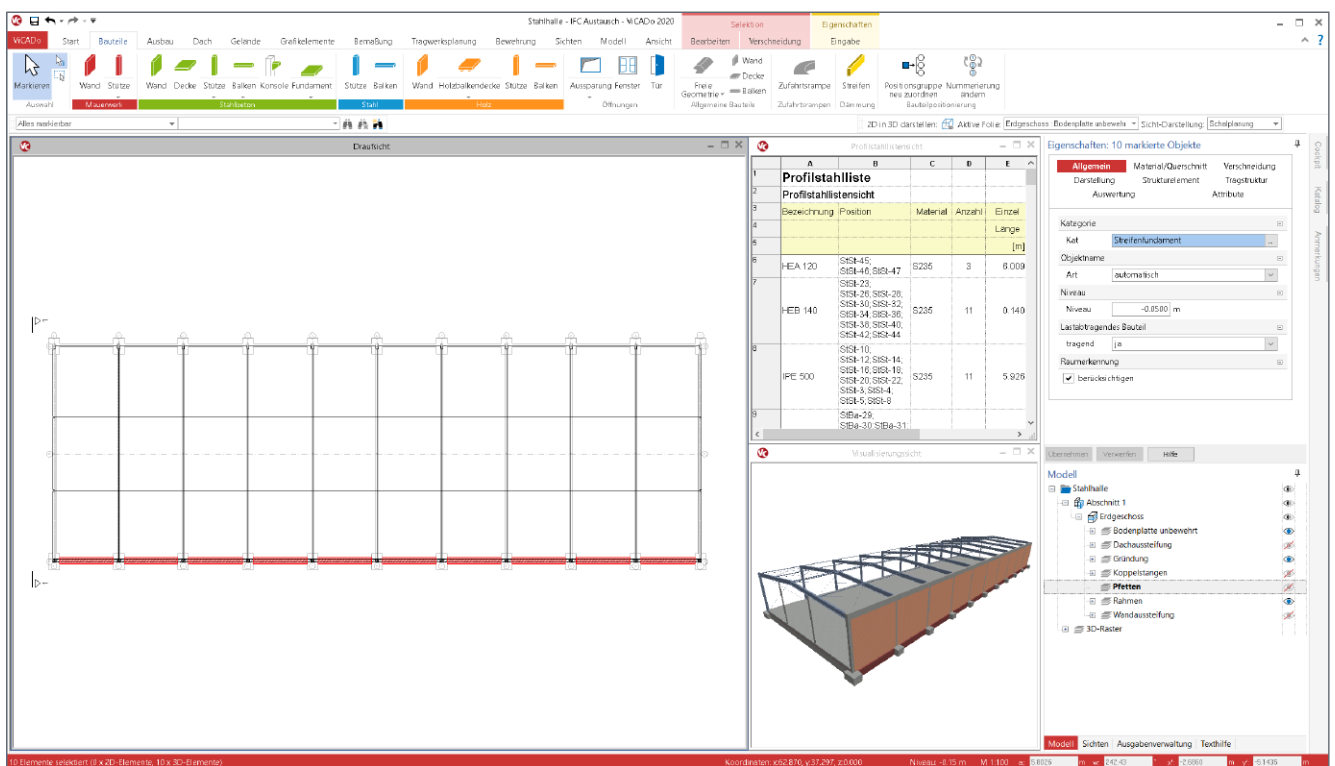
Virtuelles Gebäudemodell einer Lagerhalle in ViCADO.arc bzw. ViCADO.insg
